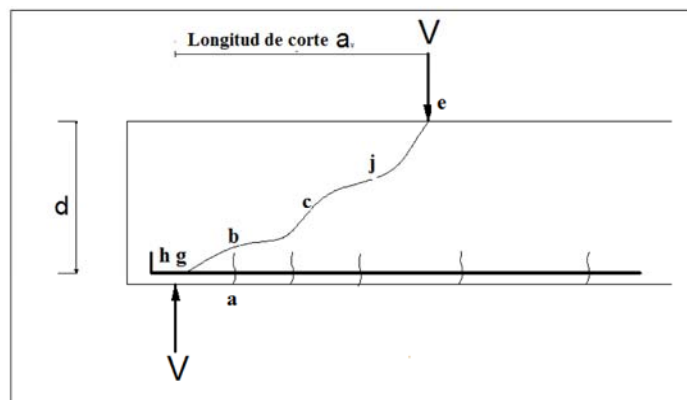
Desarrollo de grietas en vigas sin estribos
